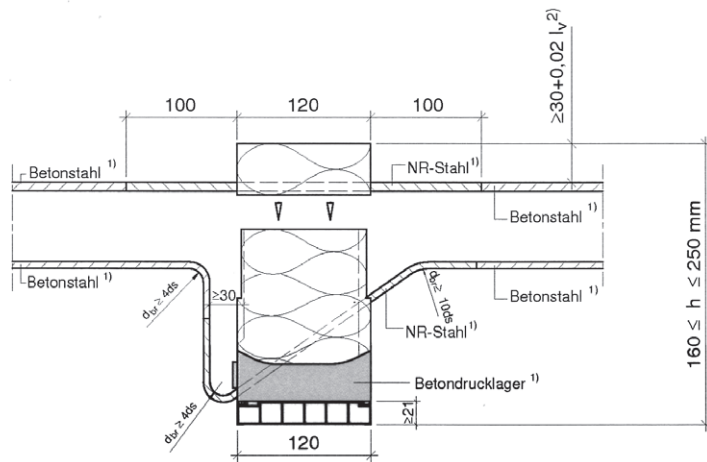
Beispiel Schöck Isokorb Typ RK-240 mit Druck- Querkraft Kombination und integrierter Aufhängebewehrung nach Abschn. 3.3.1, Z-15.7-240
